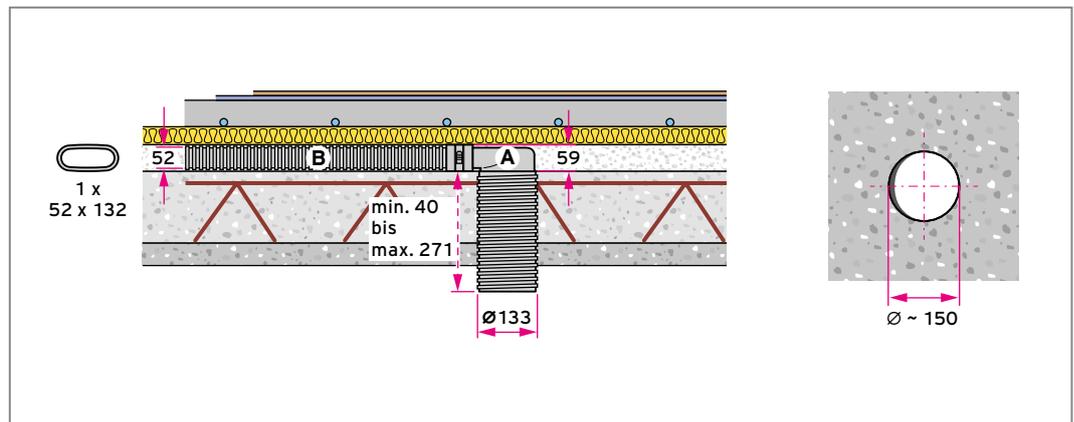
Runder Luftein- /auslass - Verlegung im Fußbodenaufbau
